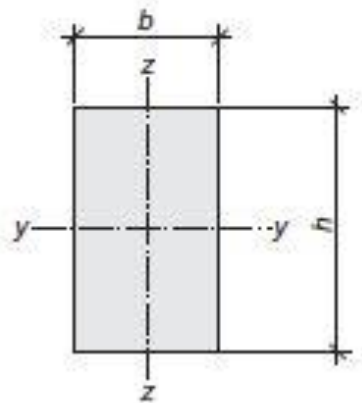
Прямоугольное поперечное сечение изгибаемого элемента
